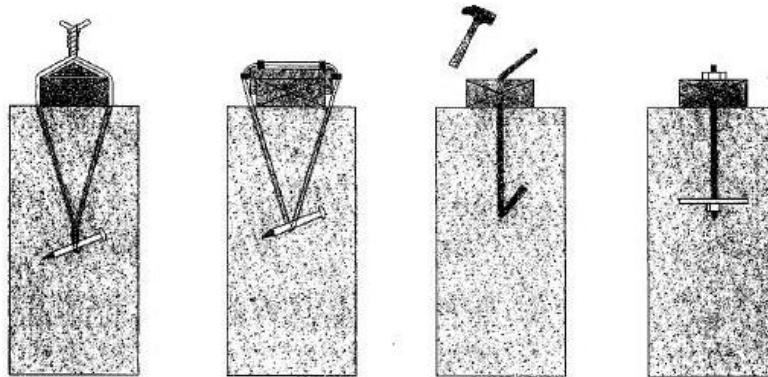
Tipo de anclaje para elementos horizontales al muro, figura 41 de (Comité national des constructions en terre, 2013)
